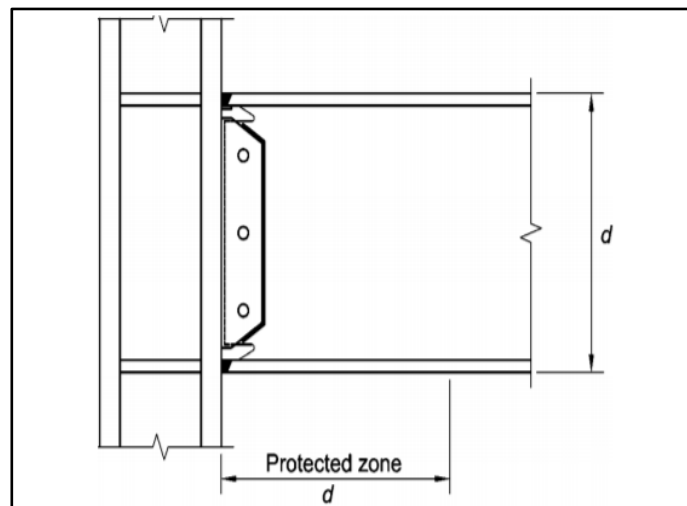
Modelo de conexión de patín soldado sin refuerzo WUF-F. AISC358 (2016)
